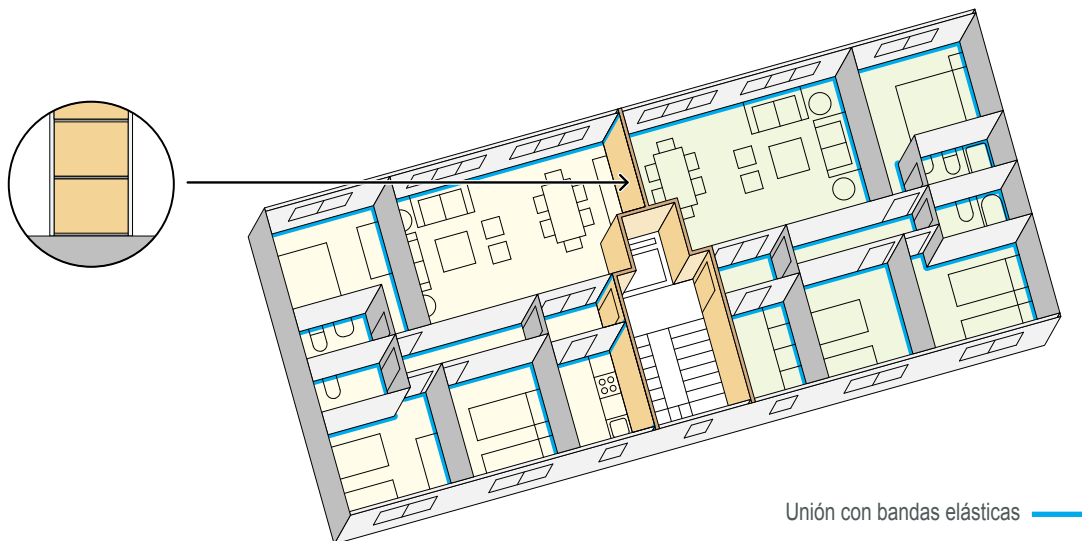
CASO 3: separadora entre viviendas de UNA hoja y edificio CON exigencia de aislamiento acústico en vertical. Colocación de bandas elásticas en los tabiques y hojas interiores de fachada.
